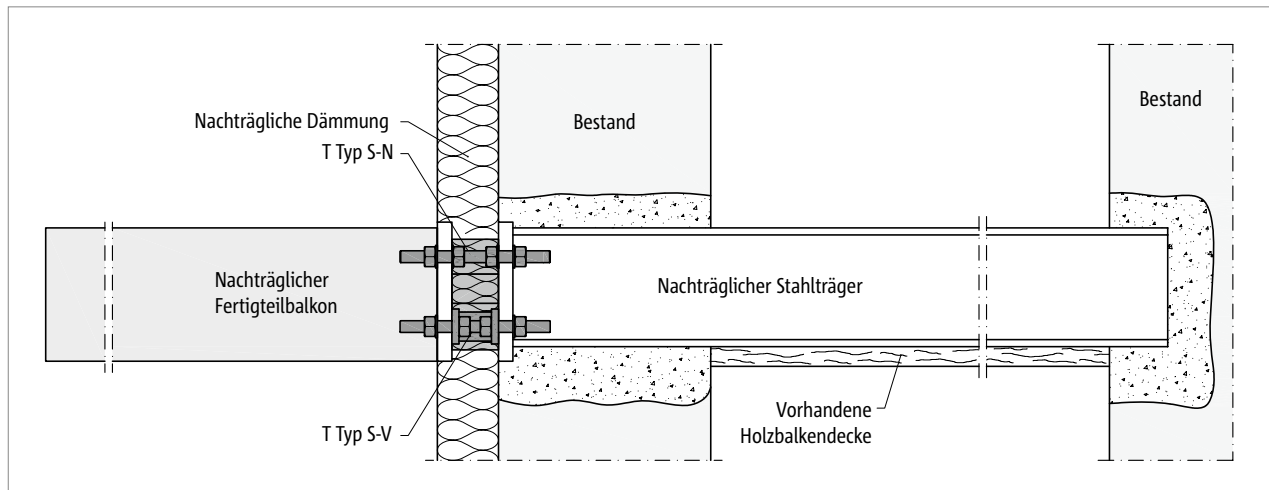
Schöck Isokorb® T Typ S-N und T Typ S-V: Nachträglicher Fertigteilbalkon frei auskragend; angeschlossen an nachträglich eingebauten Stahlträger; Verschraubung innenliegend
